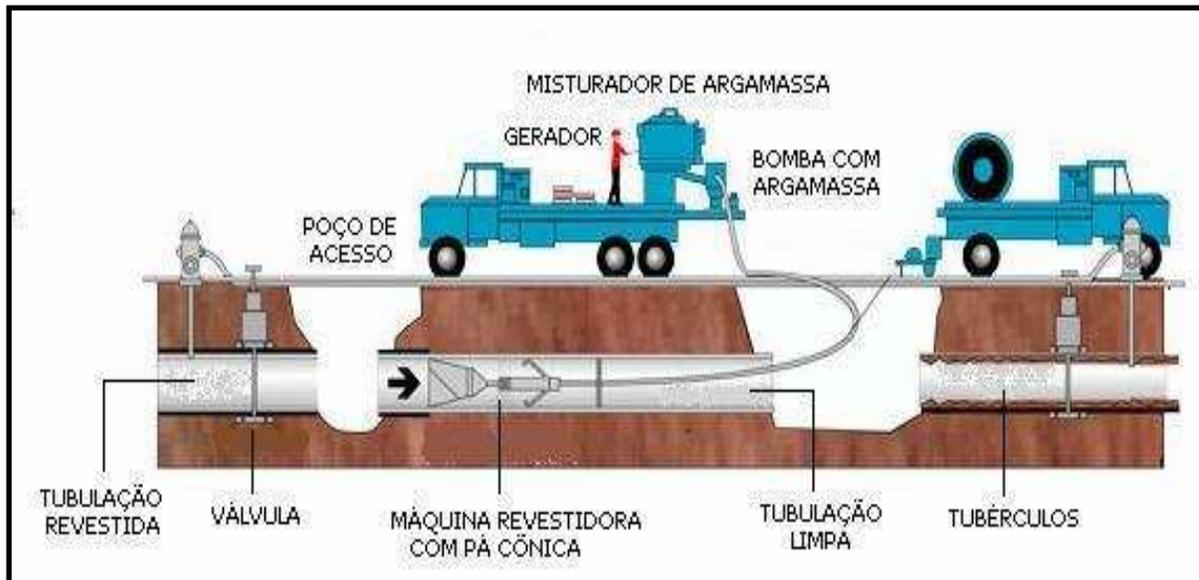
Aplicação de argamassa de cimento em tubulações de pequenos diâmetros
